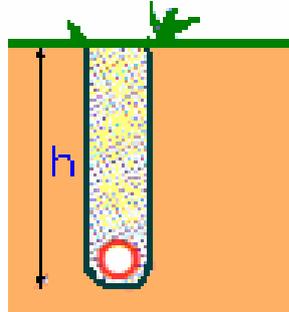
Detalle transversal de un drenaje longitudinal de Zanja.
